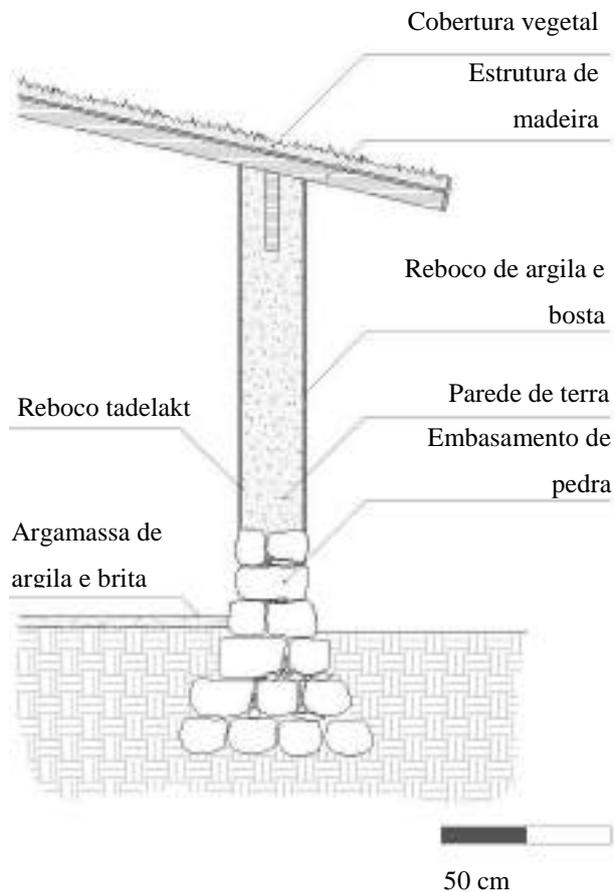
Corte construtivo (Fonte: Marco Andrade, 2019)
